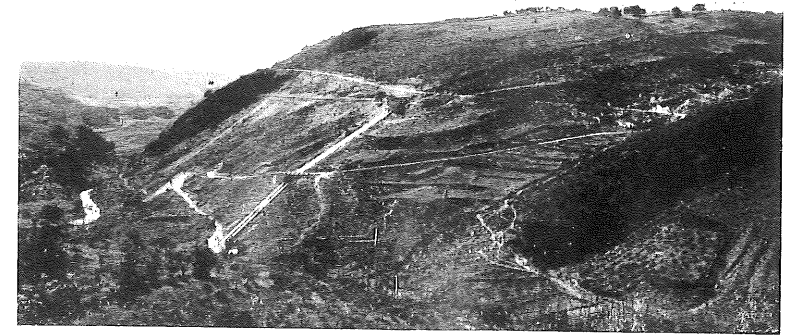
(D-1). Detalle A, de la fot. 32.
